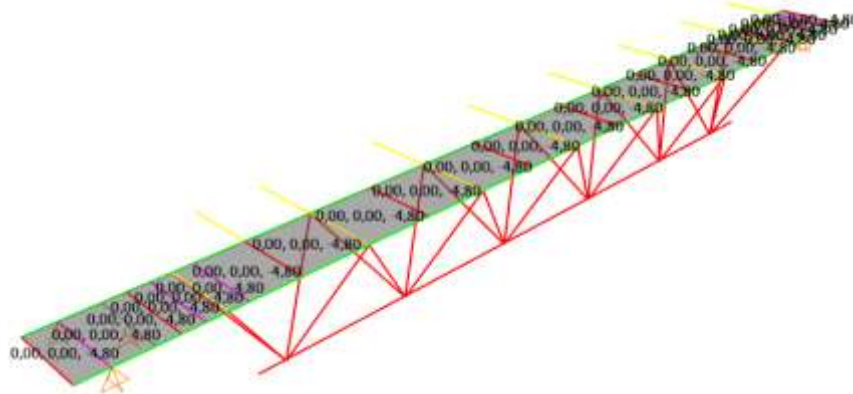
Beban Pemeliharaan (ML) yang diterima Struktur *Catwalk 11
